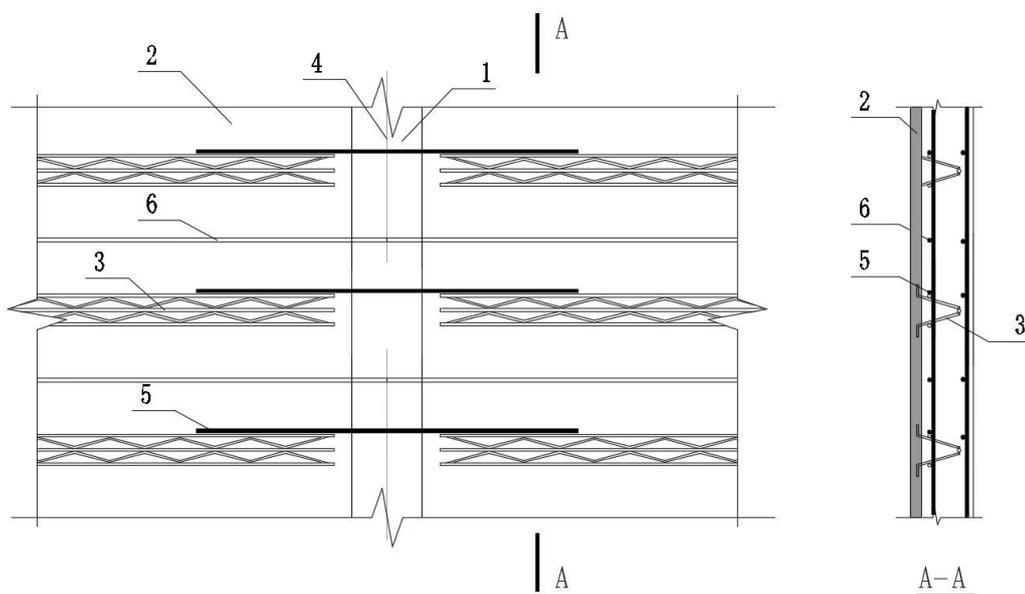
钢筋桁架保温楼承板钢筋设计示意
